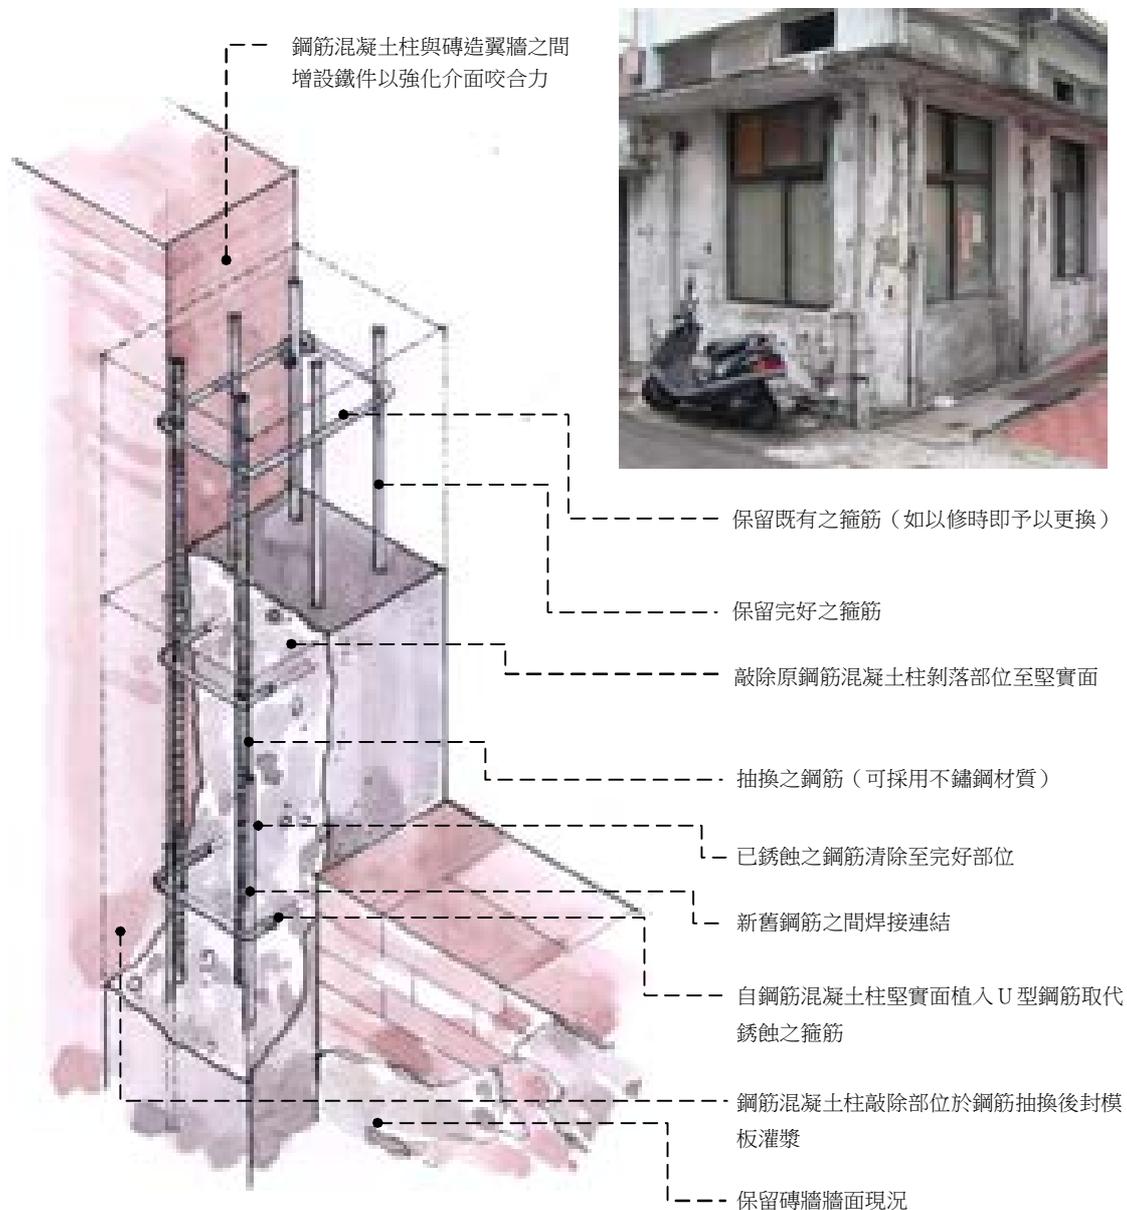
臺中市第四市場鋼筋混凝土柱修復方式建議示意圖
